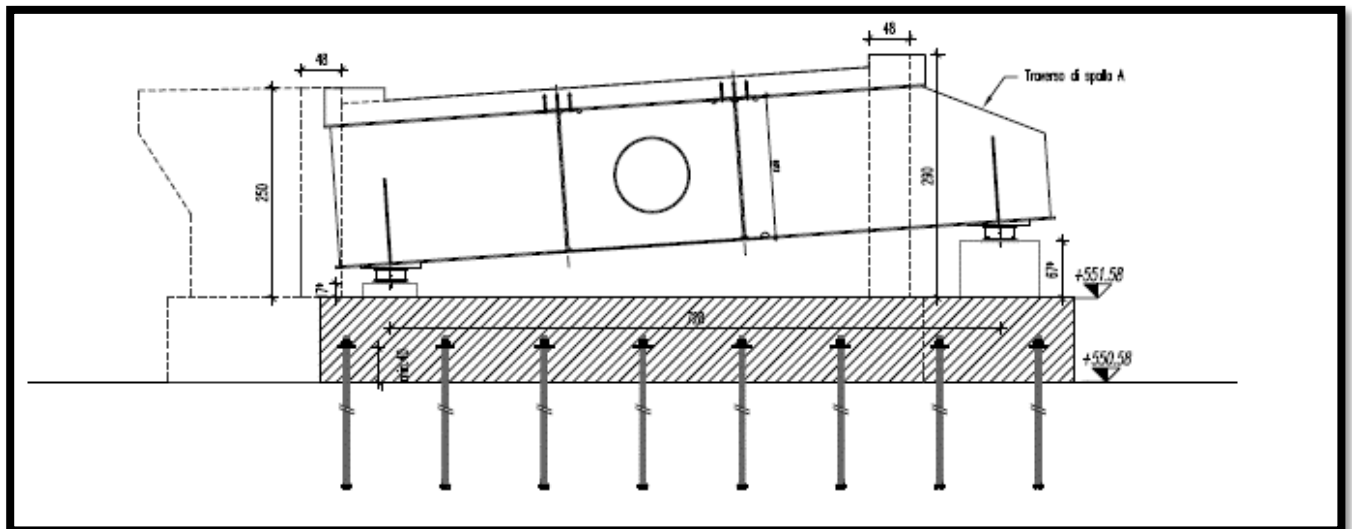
sezione della spalla A (spalla sx)
